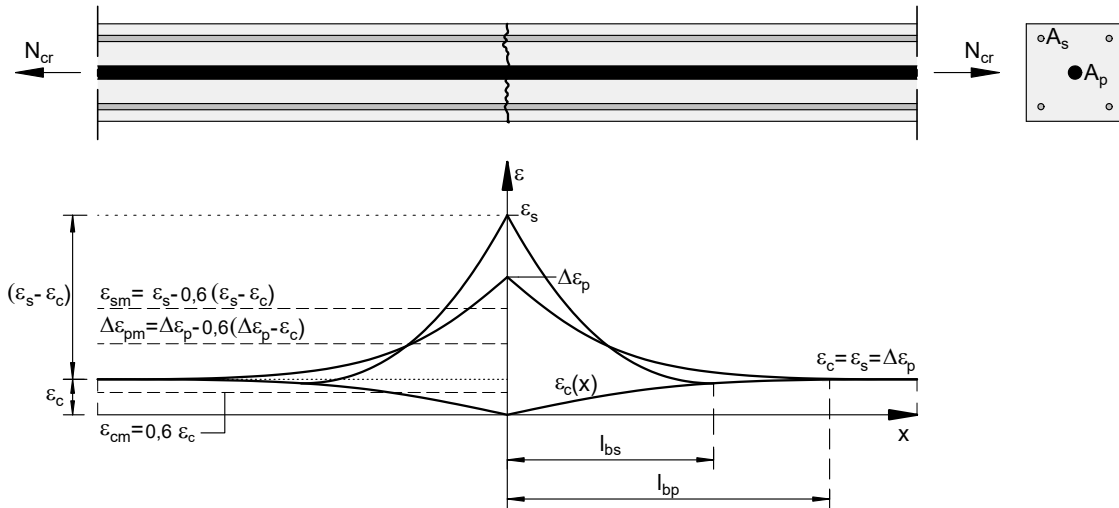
Verlauf der Dehnungen in Spannstahl, Betonstahl und Beton für den Einzelriss
